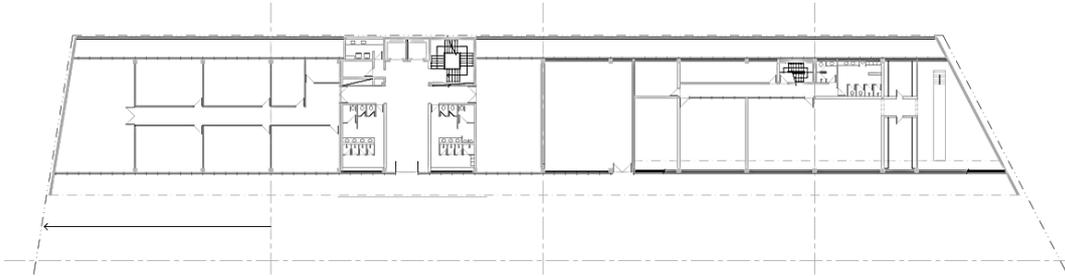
Bloco F, Planta do térreo. Fonte: Arquivo da PGR.
